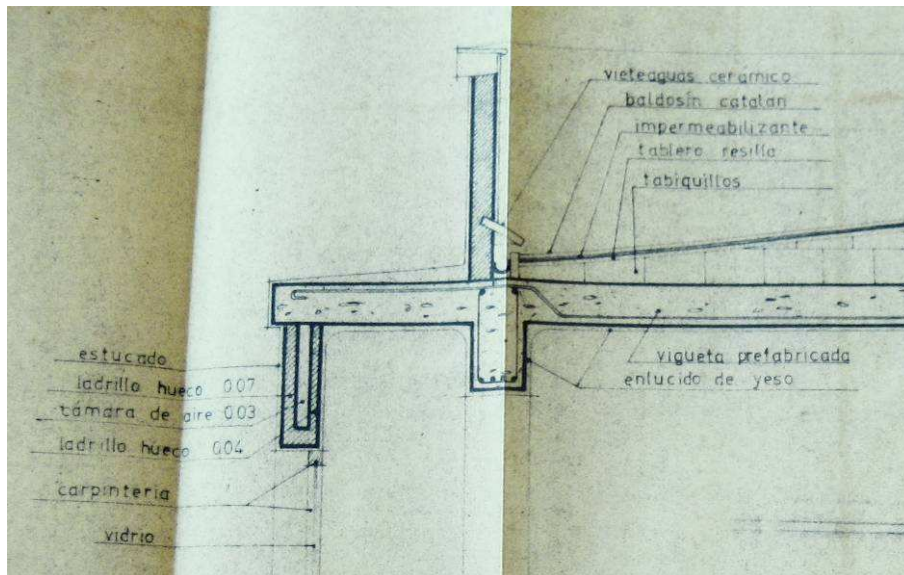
Detalle de cubierta. Edificio 33C.011, 1968.
